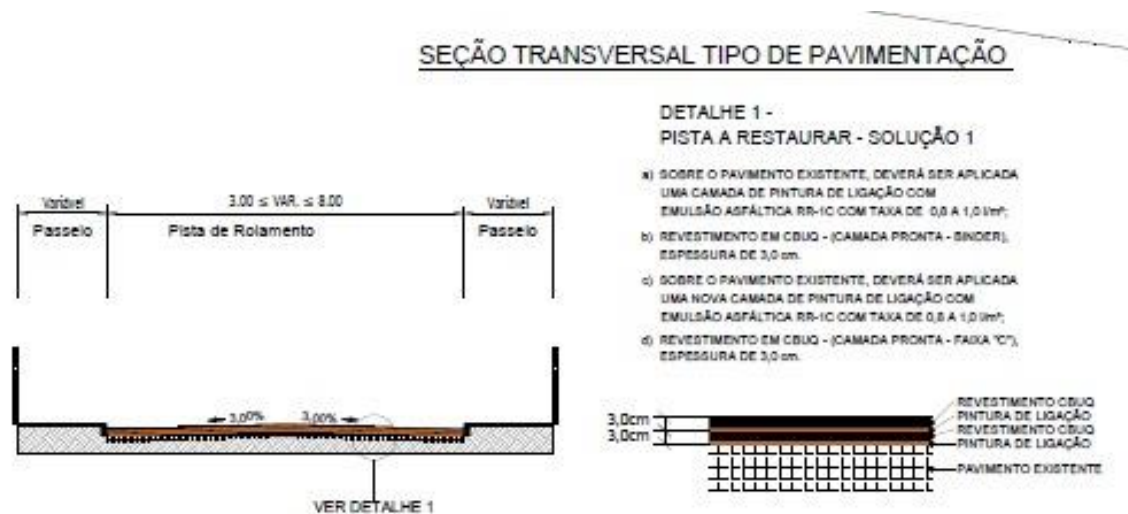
Representação em corte da espessura da pavimentação asfáltica
